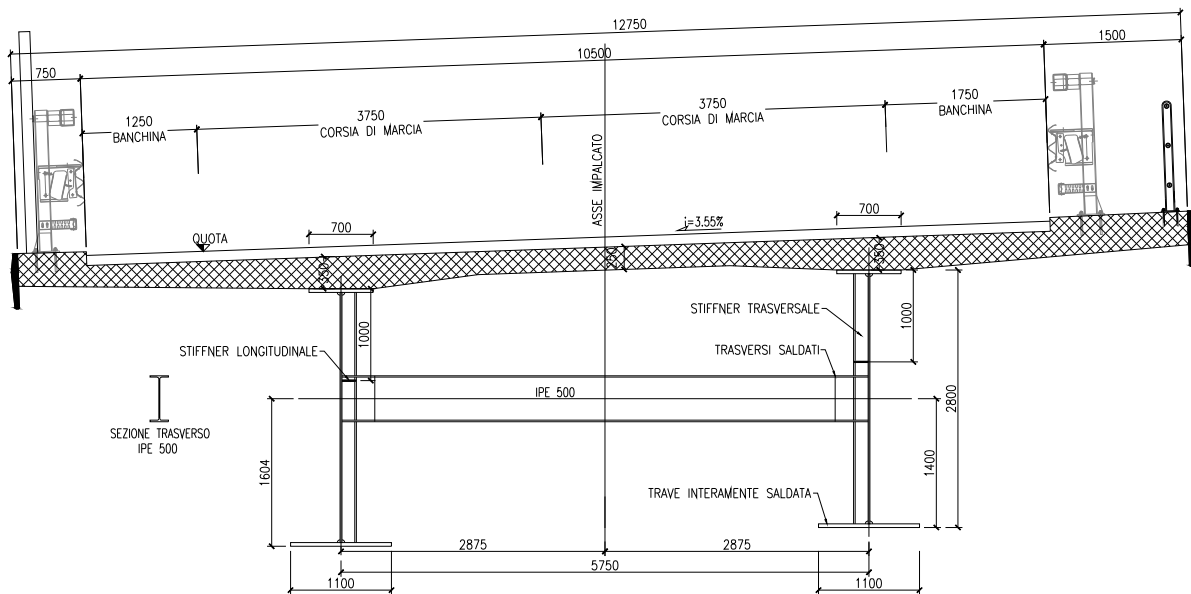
Sezione trasversale tipo dell'impalcato.
